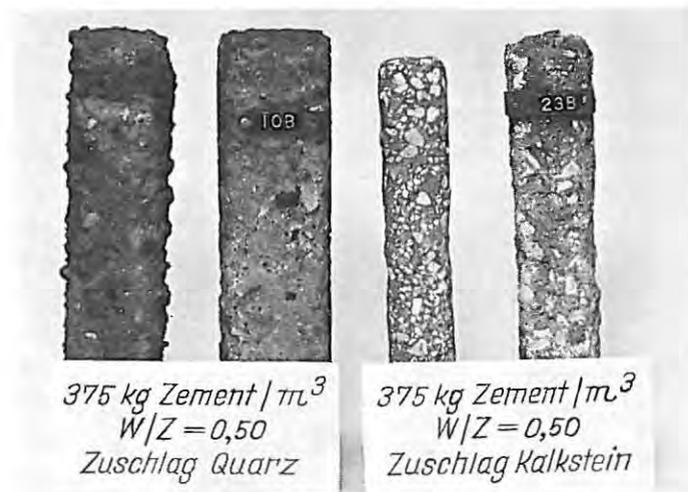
Feinbetonprismen nach 20 Jahren Lagerung in Wasser mit kalklösender Kohlensäure; Einfluß der Zuschlagart
